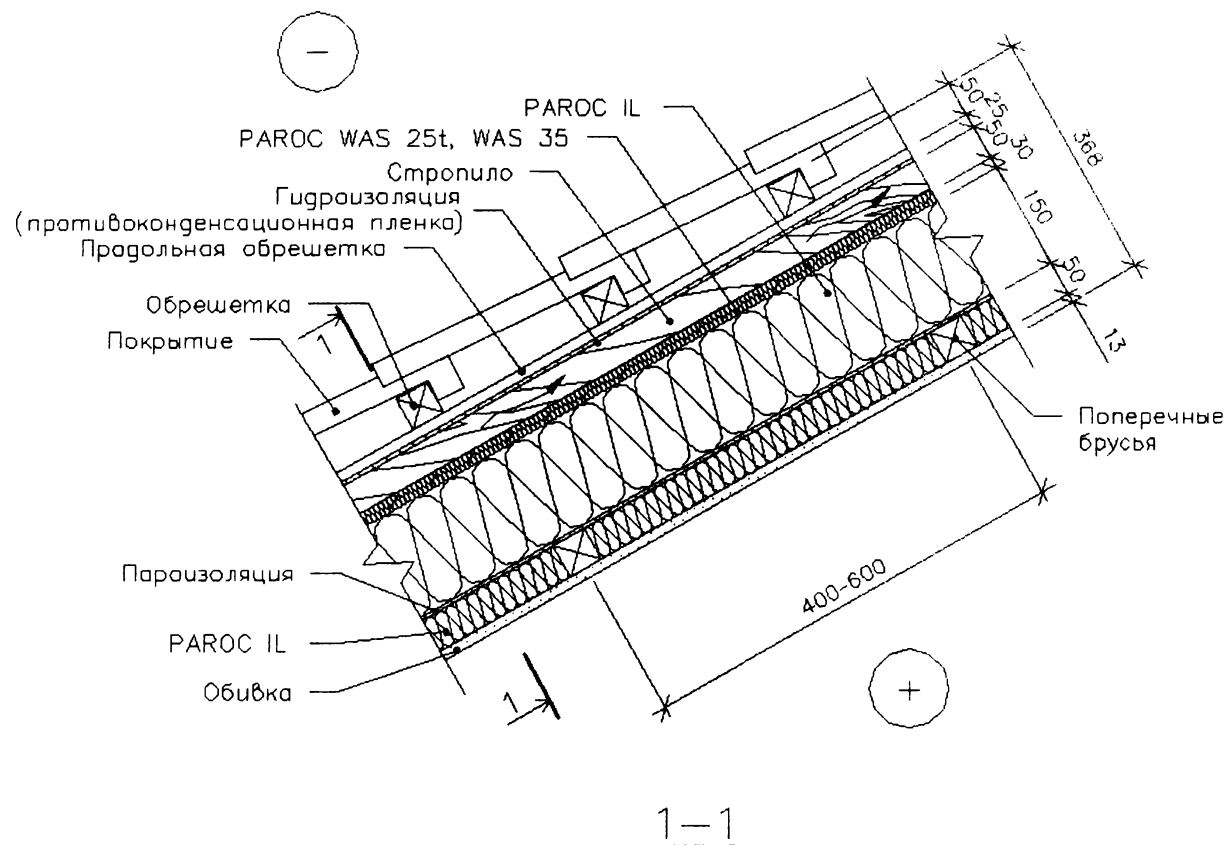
Скатная крыша с черепичным покрытием и паропроницаемой гидроизоляционной пленкой
